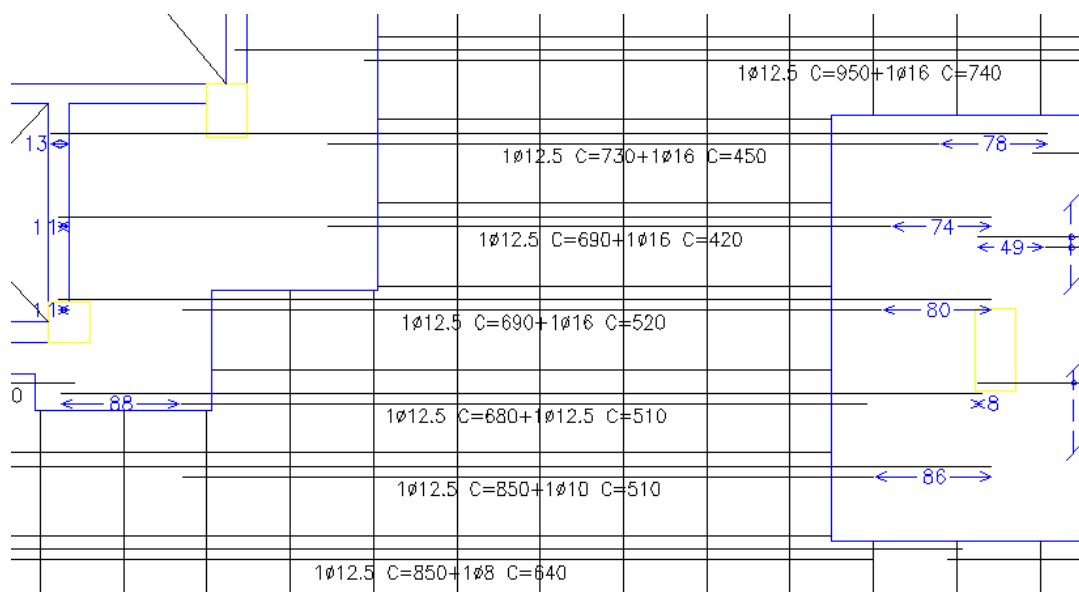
Detalhamento da armadura positiva para um trecho de laje nervurada.
